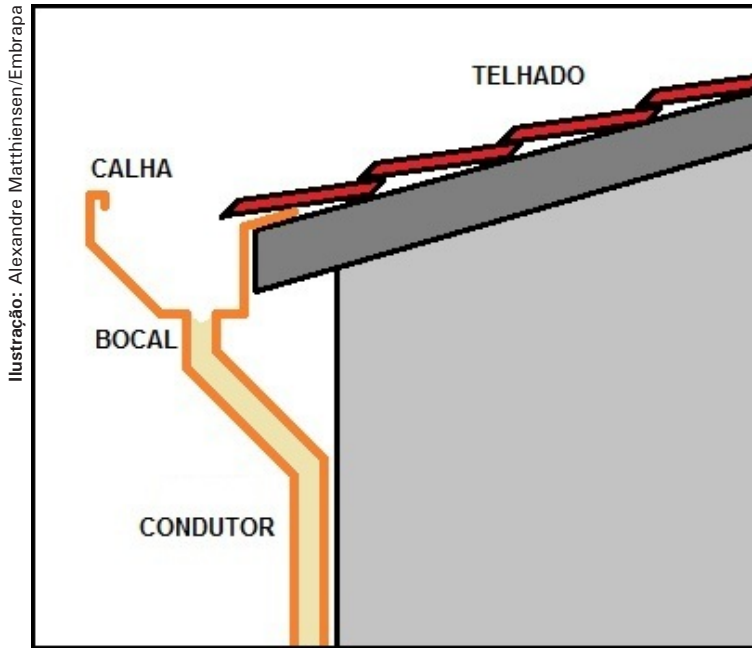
Ilustração de instalação do sistema de calha e cano condutor
